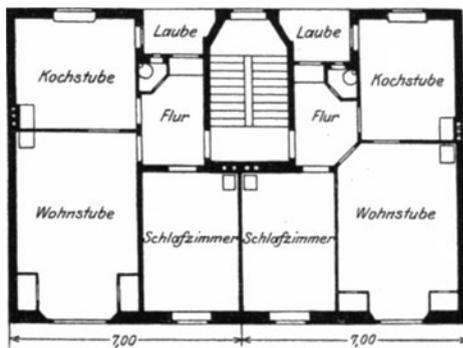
Grundriß einer Kleinwohnung. (Nach Nußbaum.)
